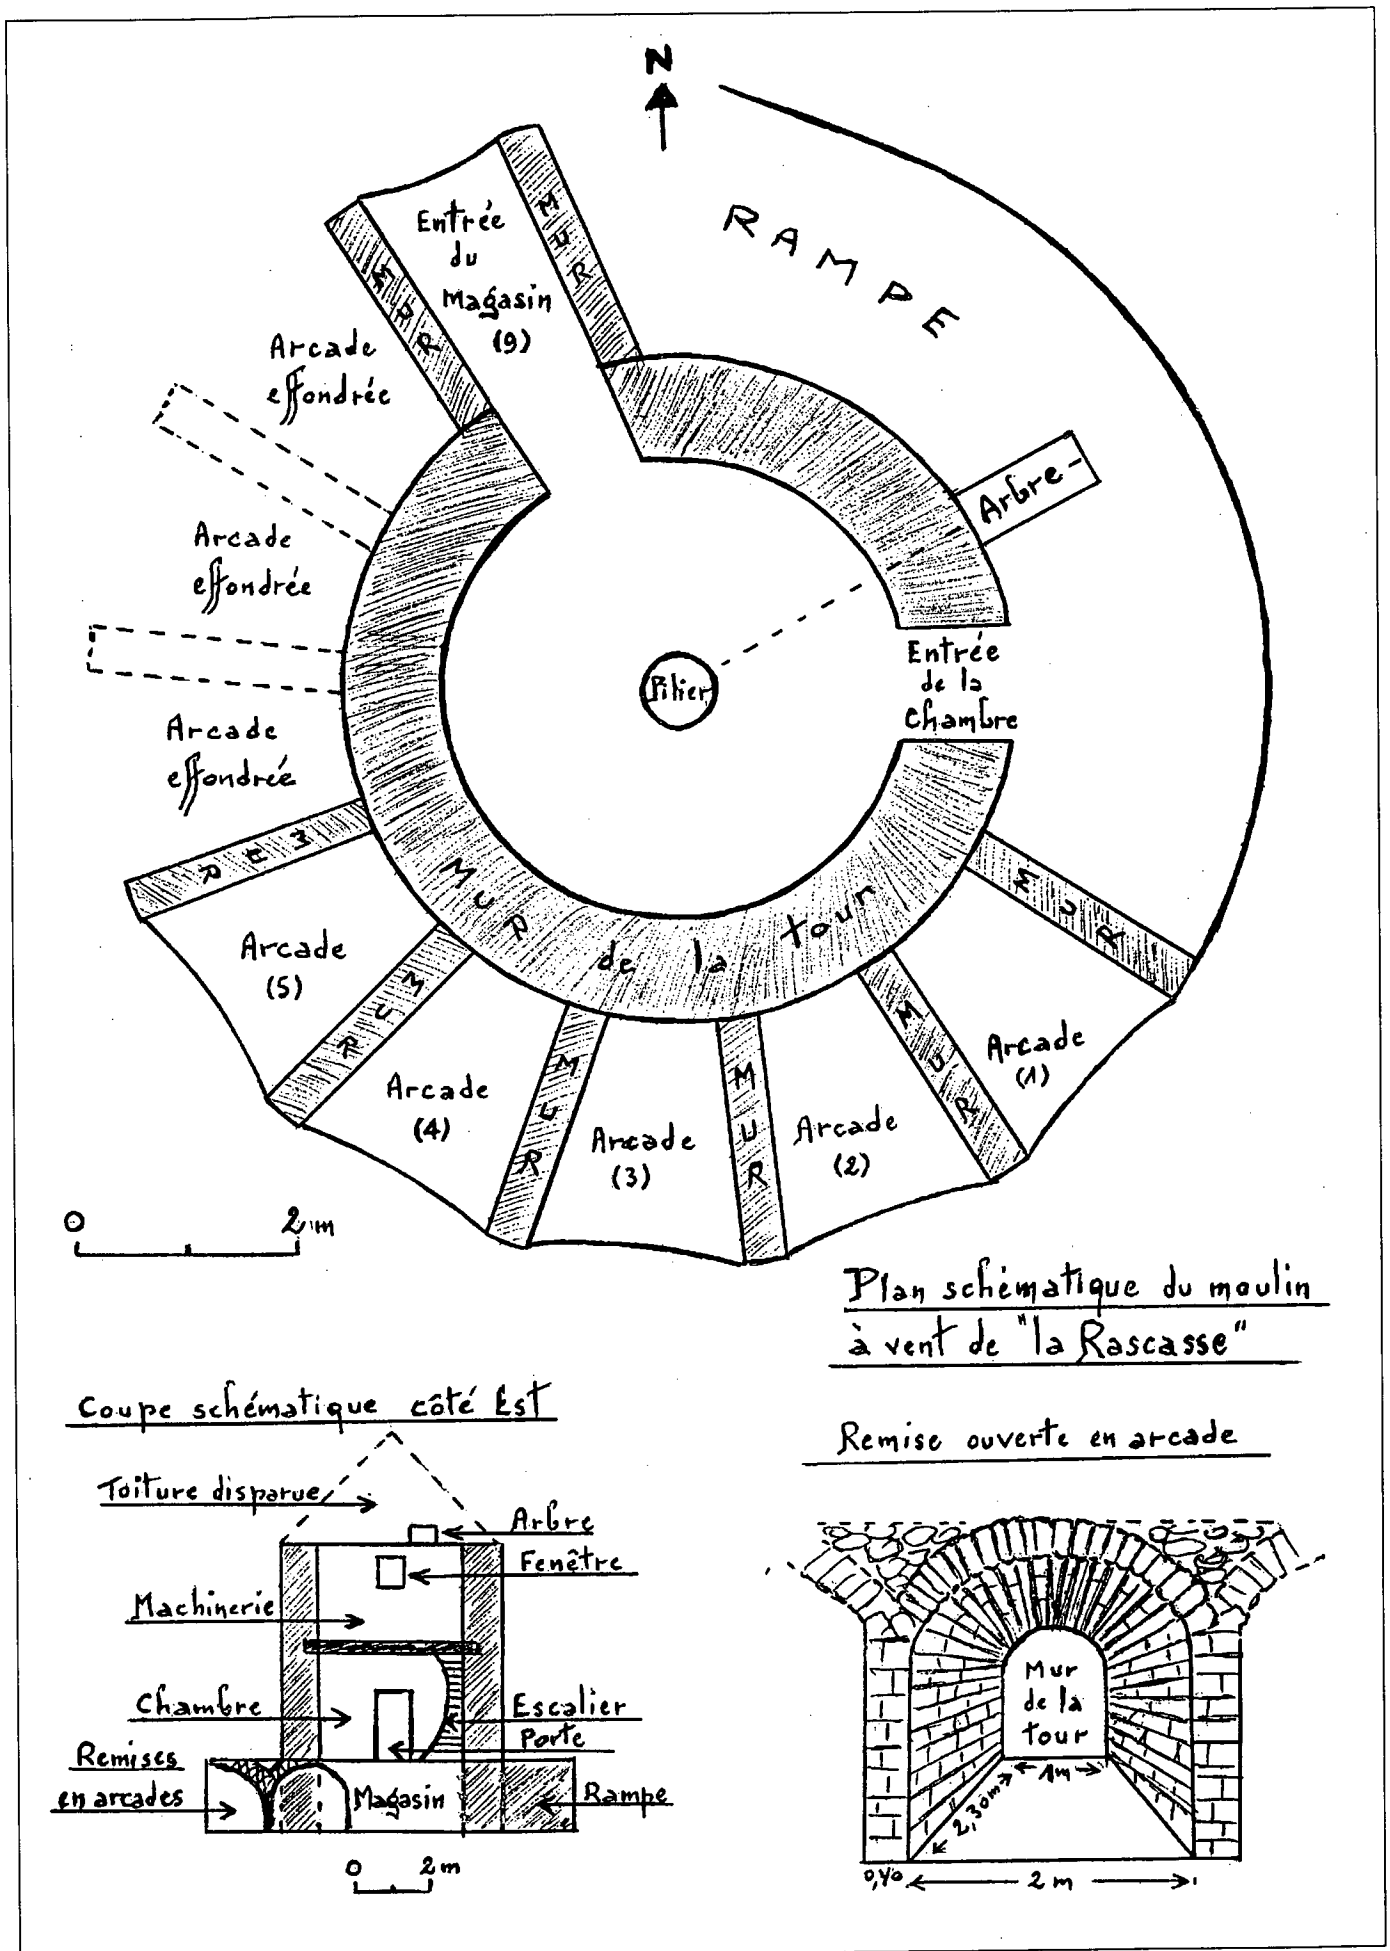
PEYPIN-D'AIGUES, La Rascasse. Plan schématique du moulin à vent ; coupe schématique côté est ; remise ouverte en arcade.
